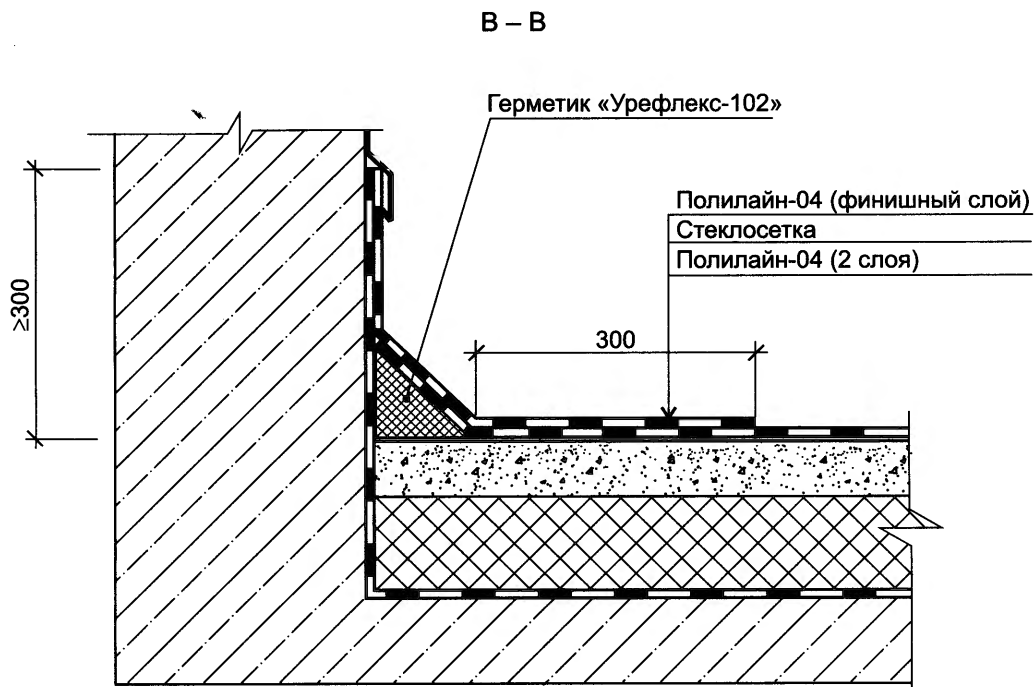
Гидроизоляция узла примыкания пола к бетонному ограждению
